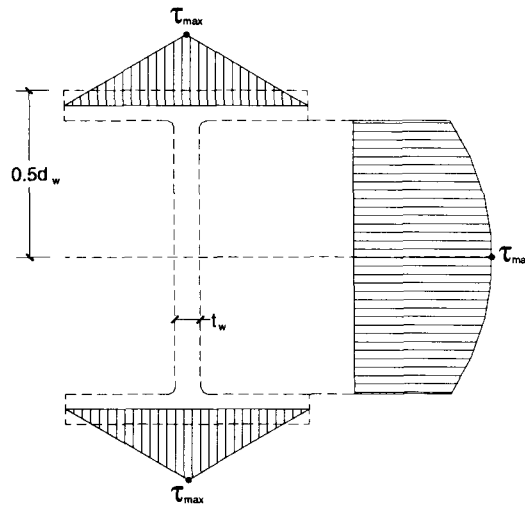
Distribución de esfuerzo cortante en una sección con perfil W debido carga vertical
